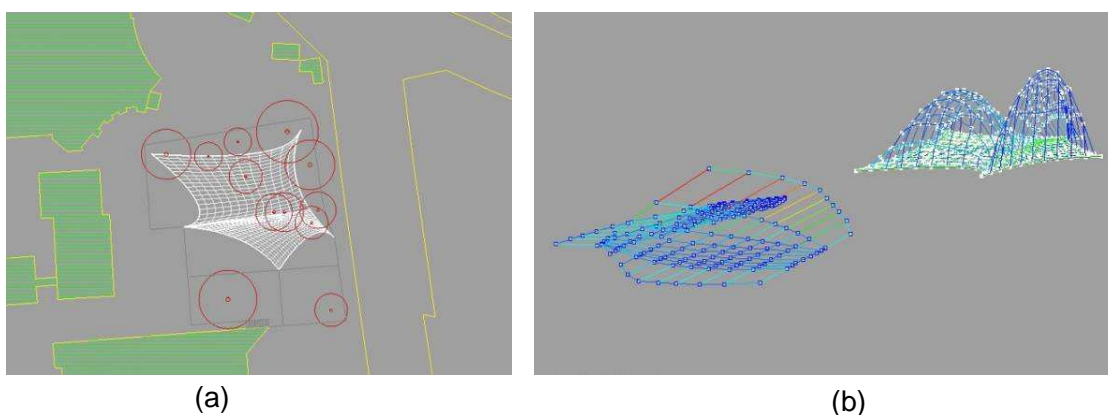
a) Grundriss mit Netz b) Stressdiagramm/Punktwolke mit intuitiven Höhen
